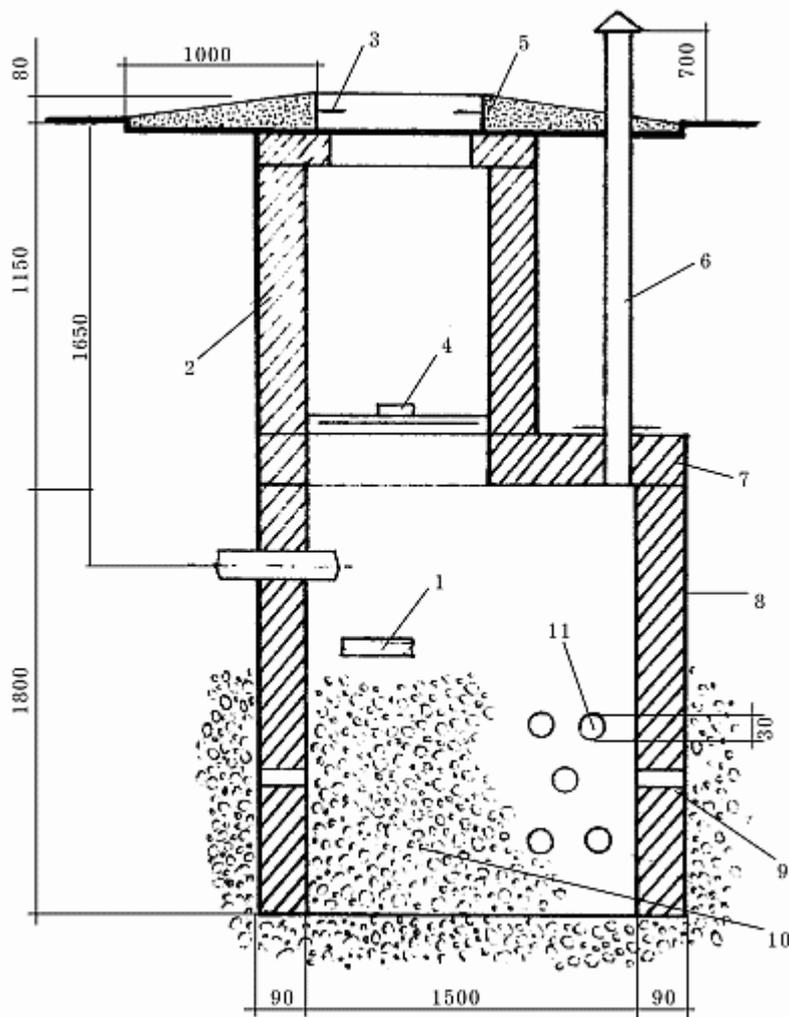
Фильтрующий колодец из сборных железобетонных элементов: 1 – водоотбойная доска; 2 – железобетонное кольцо; 3 – чугунный люк или деревянная крышка;
